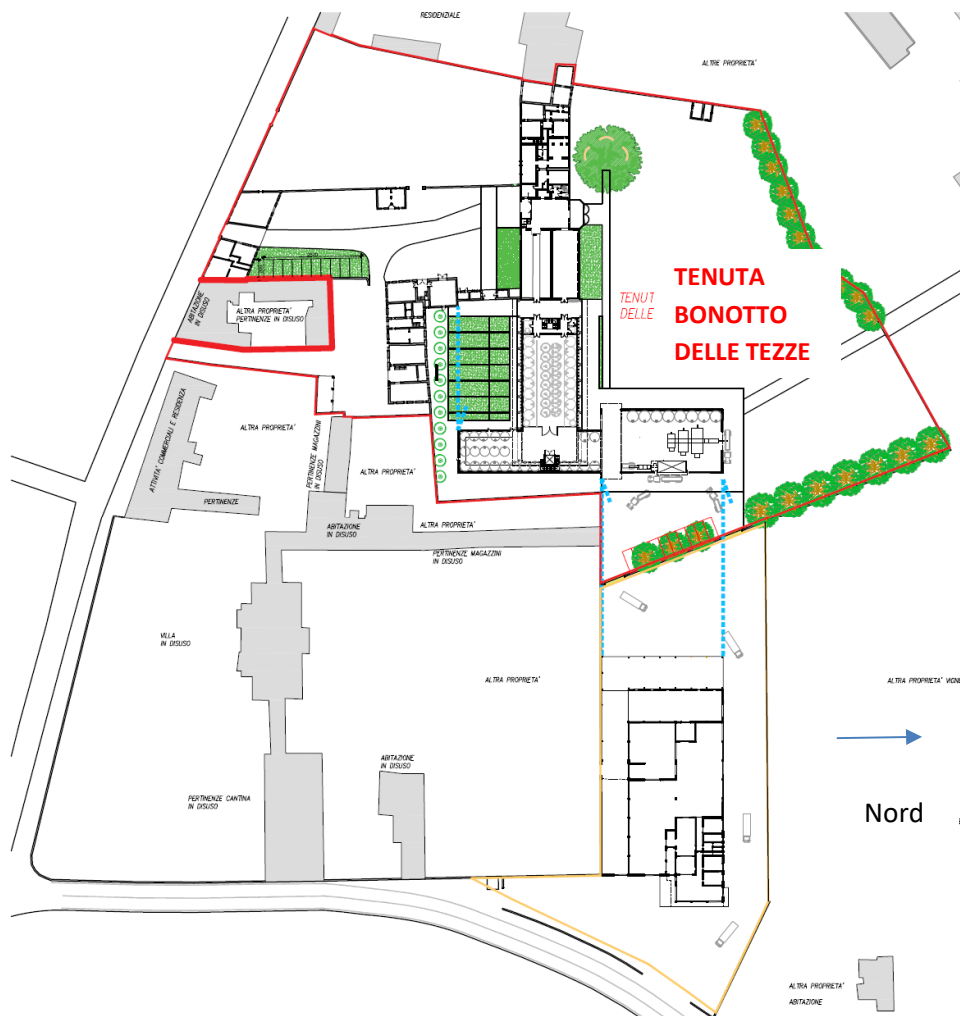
Planimetria con Ambito Tenuta Bonotto delle Tezze (rosso), Ambito ex Zanon (giallo), allineamenti preservati (azzurro), viabilità pubblica.
